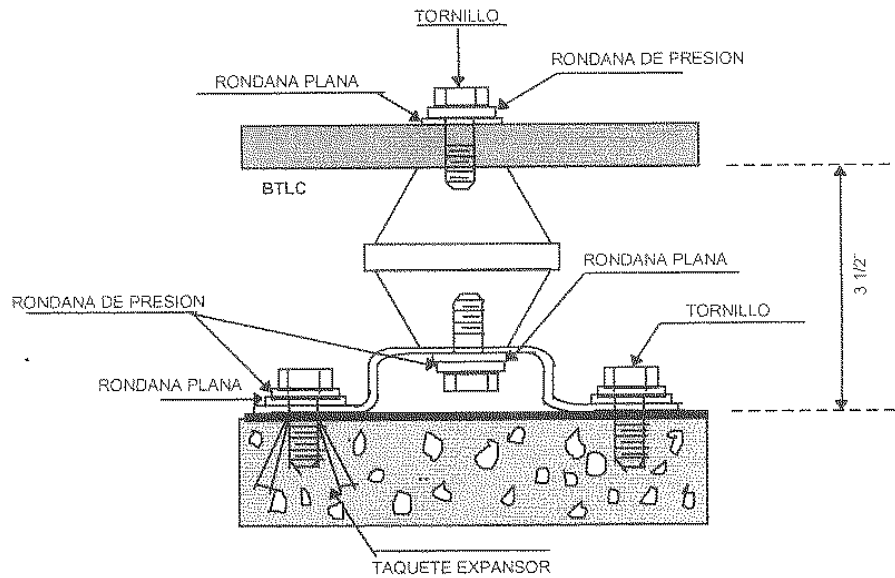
Diagrama de la tornillería para Fijar a Muros y Estructuras Metálicas.
